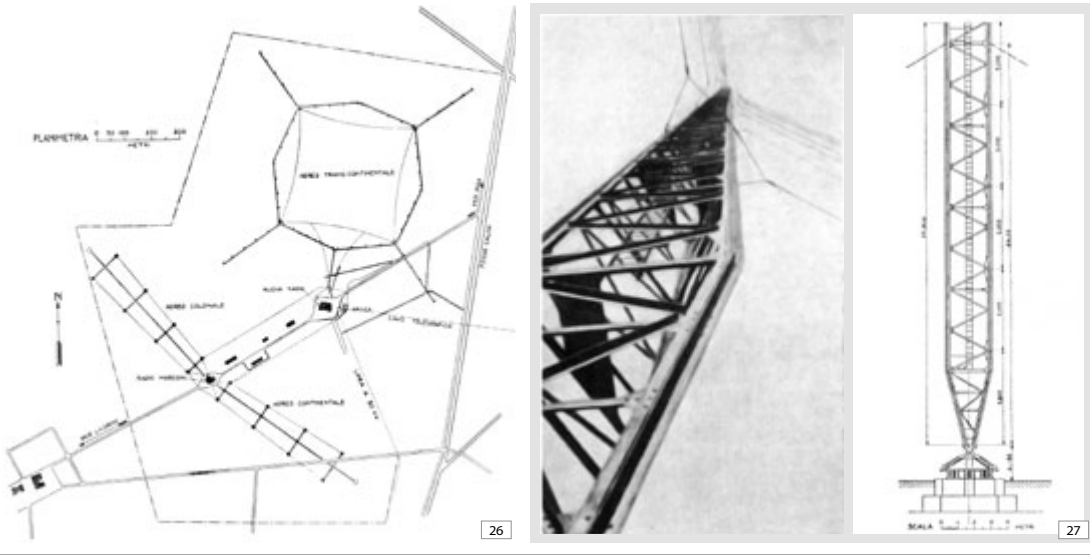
Planimetria della stazione sperimentale di Coltano (Pisa).
